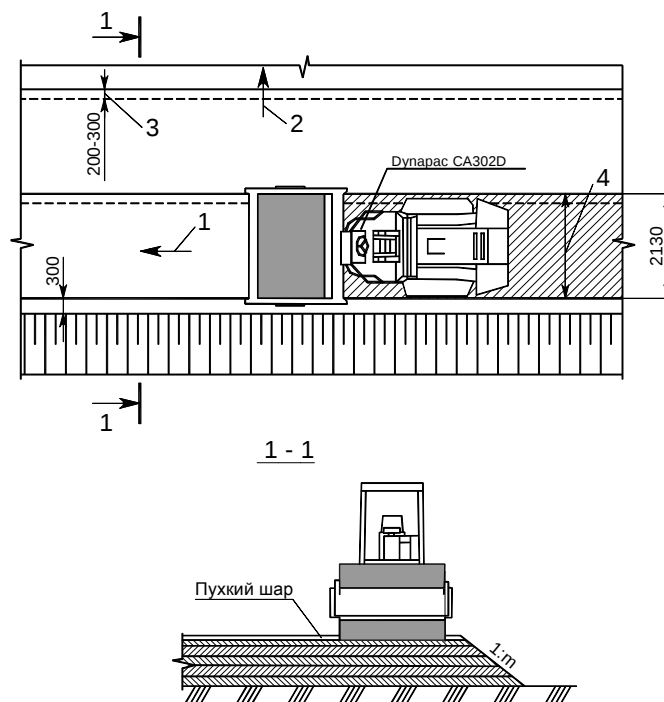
Схема ущільнення ґрунту укочуванням: 1 – напрямок укочування від країв до середини; 2 – загальний напрямок робіт на ділянці; 3 – перекриття попередньої смуги; 4 – ширина смуги
